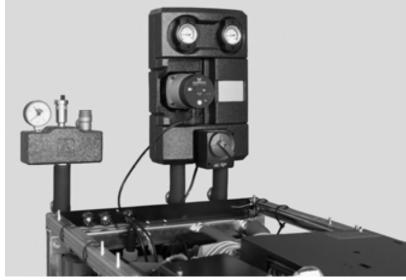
Sicherheitsgruppe aufschrauben und ausrichten. Lage des O-Ringes kontrollieren und Kontermutter anziehen.
